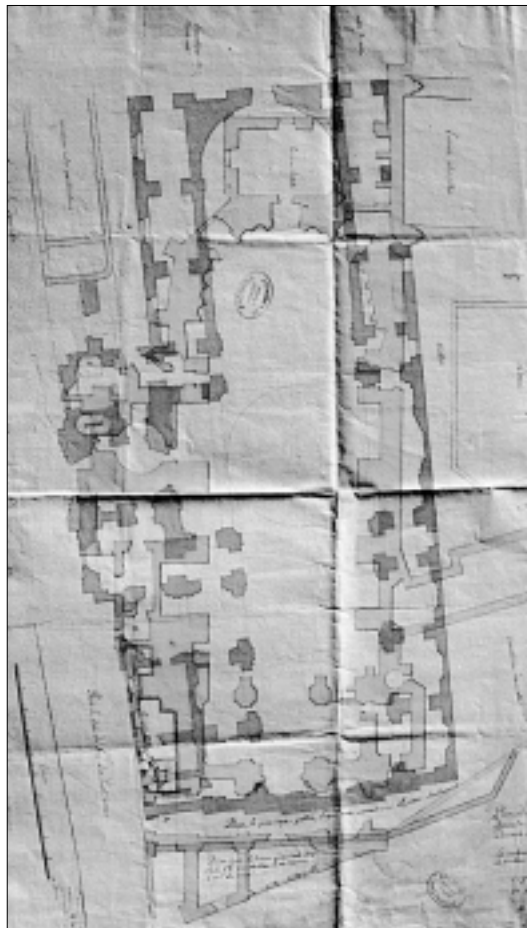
PLAN DE LA DAURADE, « D'APRÈS L'ORIGINAL », A.D. Hérault, C 498-1 (1). Cliché G. Durand.
